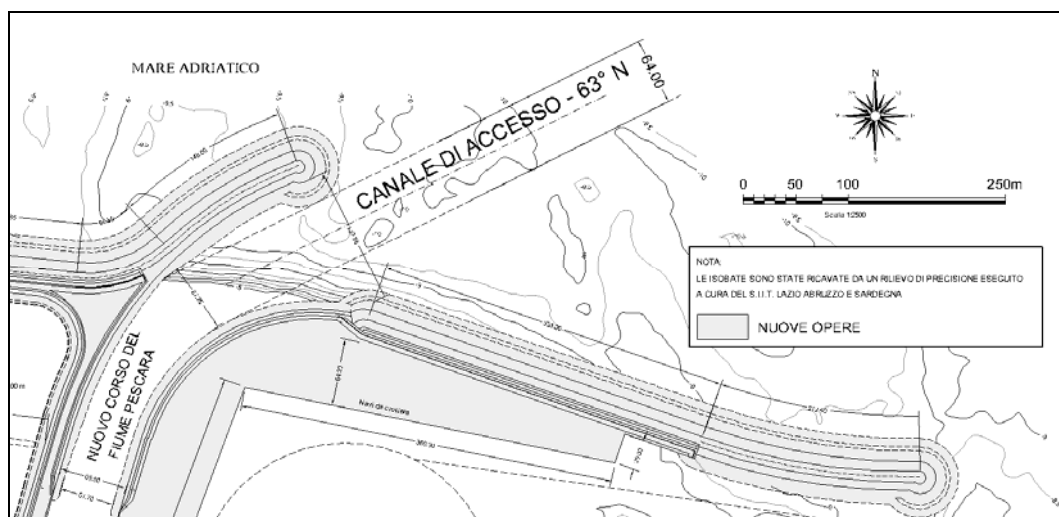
Foce fiume Pescara: planimetria di progetto con l'indicazione del canale di accesso
